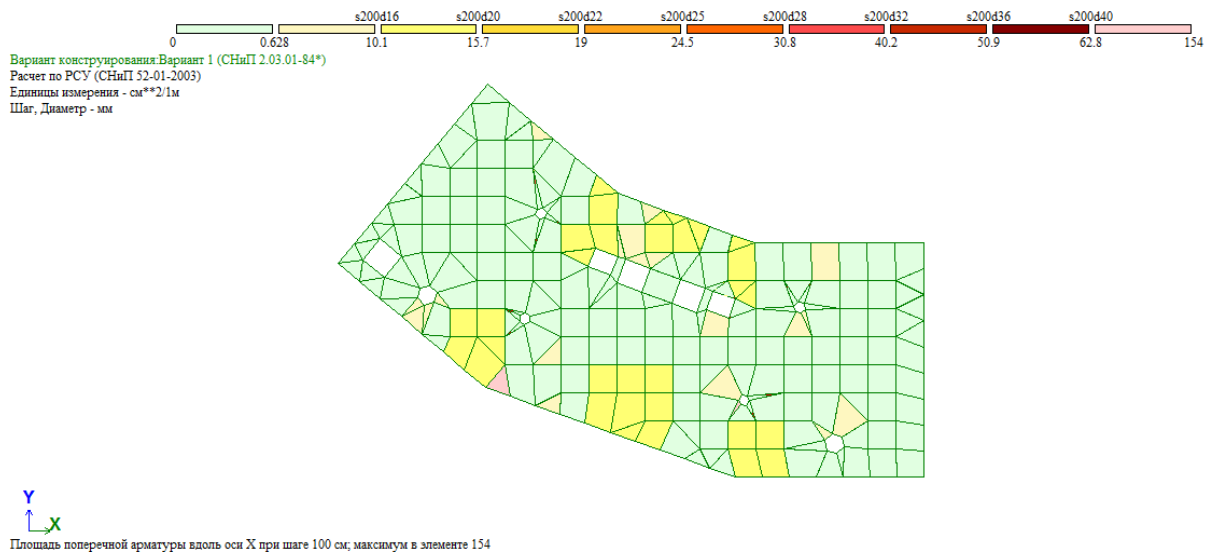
Площадь поперечной арматуры вдоль буквенных осей
